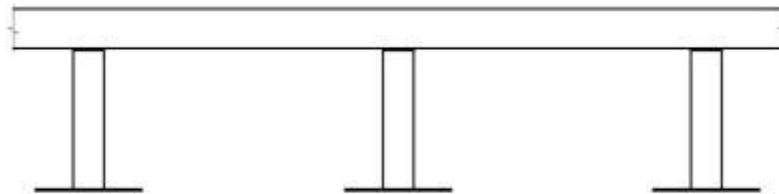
Esquema de ponte em viga simplesmente apoiada com extremidades em balanço
